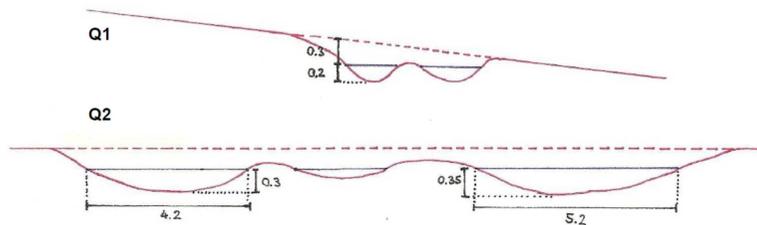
Plan Massnahme 11 (Planzeichnung: THOMAS HERTACH)
